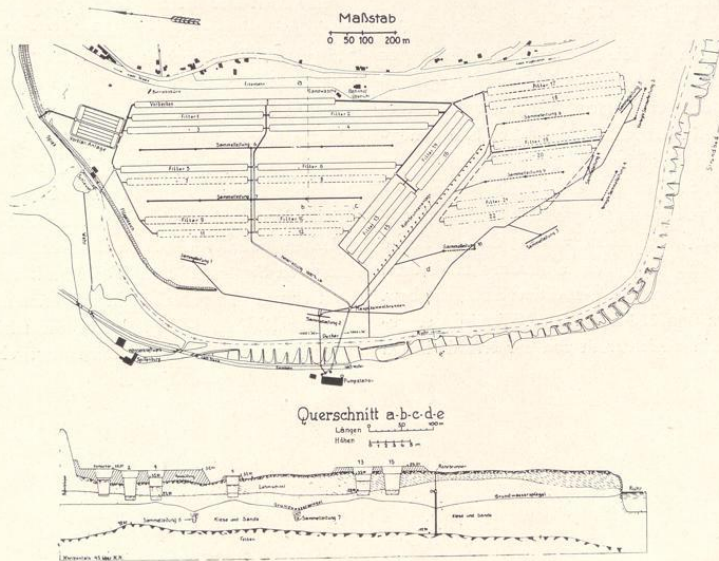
Plan der Essener Wassergewinnungsanlagen
